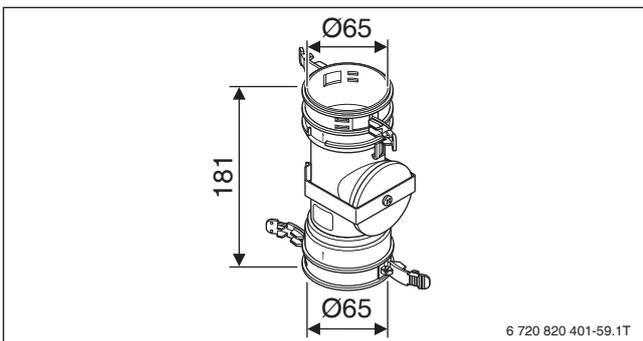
Verbindungsstück Flex mit Prüföffnung Ø 60 mm (Maße in mm)
